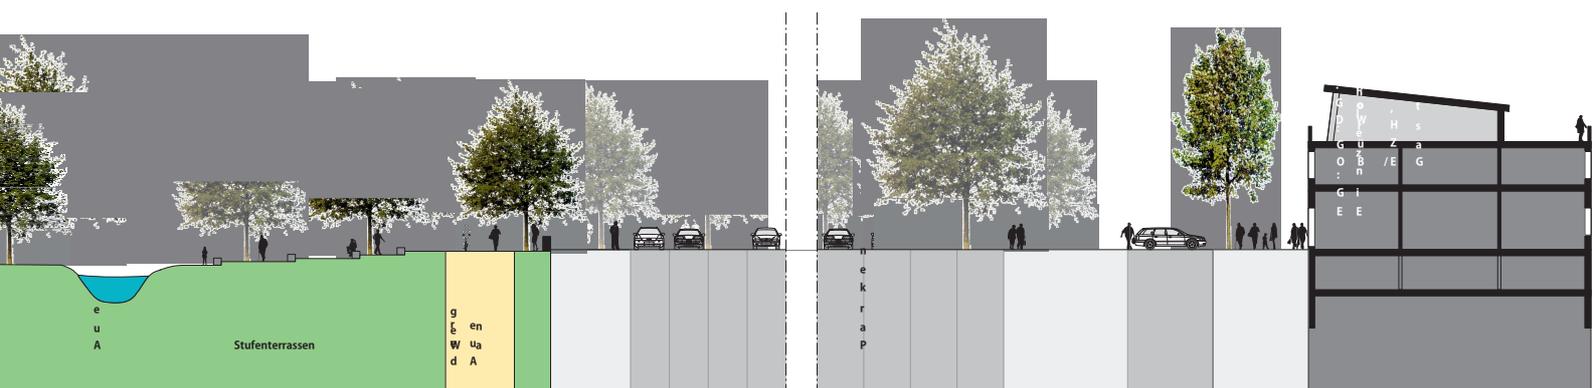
/5 Schnitt mit Blick nach Westen [ohne Maßstab]
